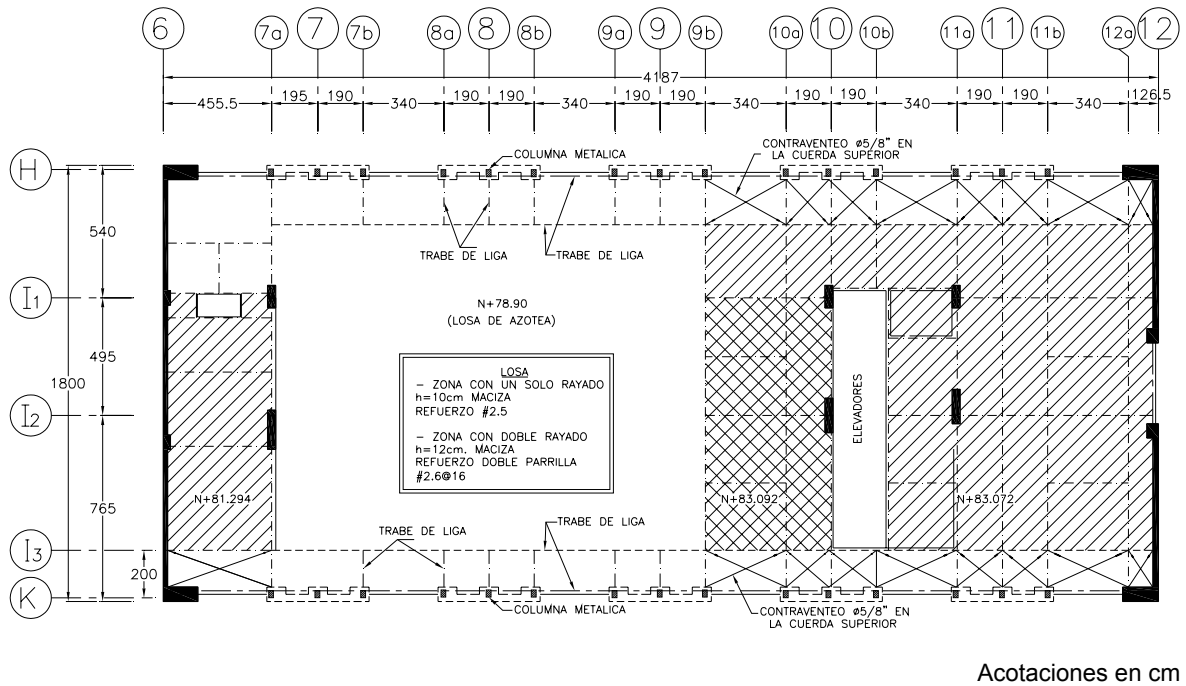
Planta piso de máquinas (Torre Mayor)
